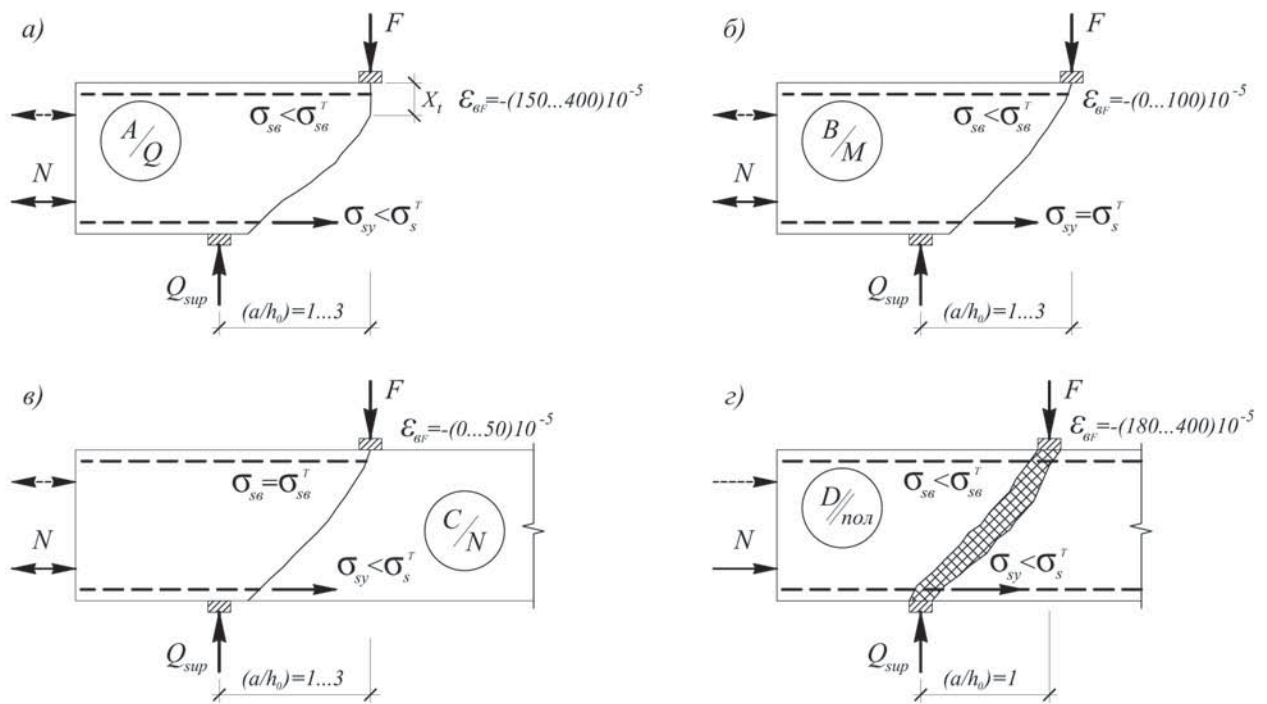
Можливі схеми руйнування припорних ділянок позацентрово розтягнутих або стиснутих залізобетонних балок від переважної дії поперечної сили (а), згинального моменту (б), поздовжньої сили (в), за похилою стислою смугою (з)
